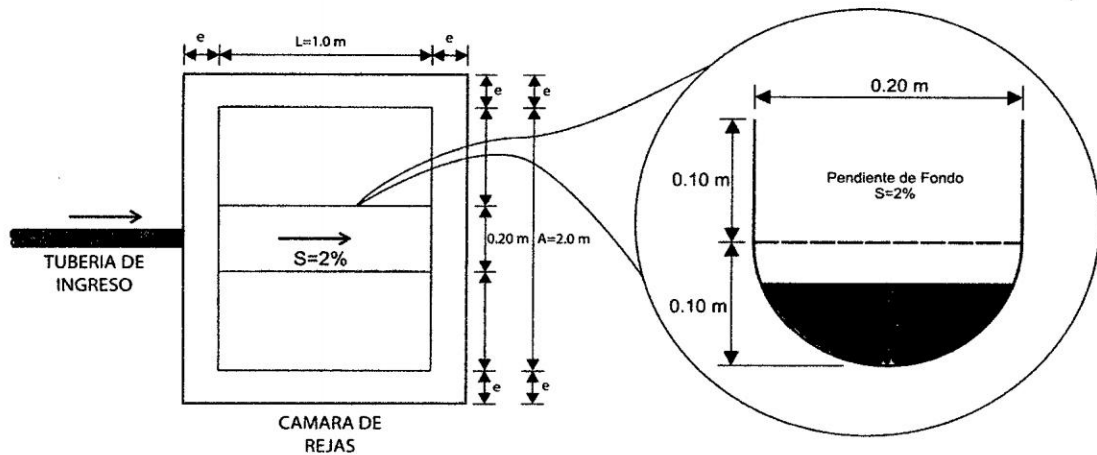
Vista en planta y Sección final de la cámara de rejillas. Fuente: Elaboración propia
